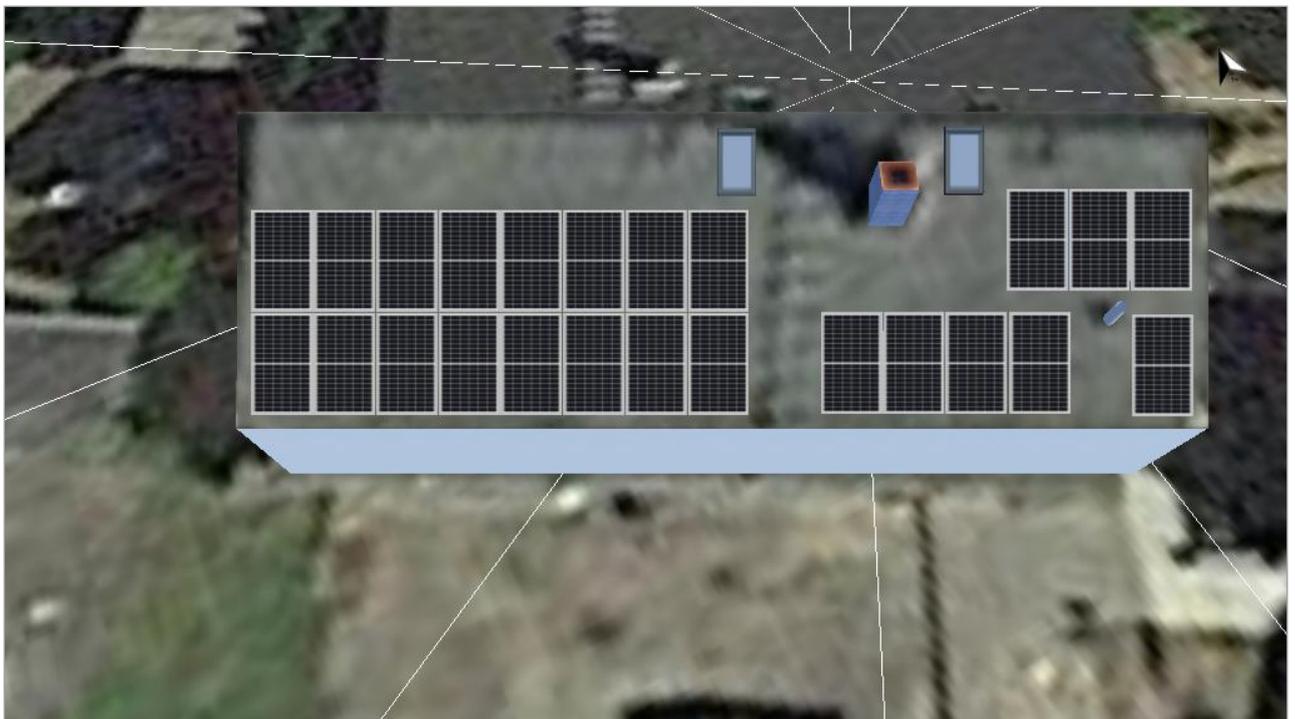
Modulfläche - Gebäude 01-Dachfläche Südwest
